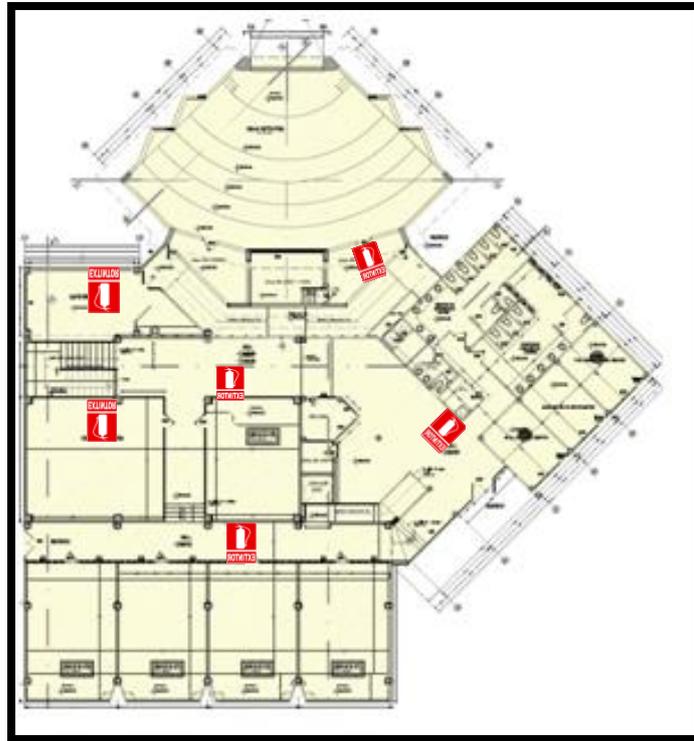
Extintores, Planta baja, Edificio 19-A, Zona 3
